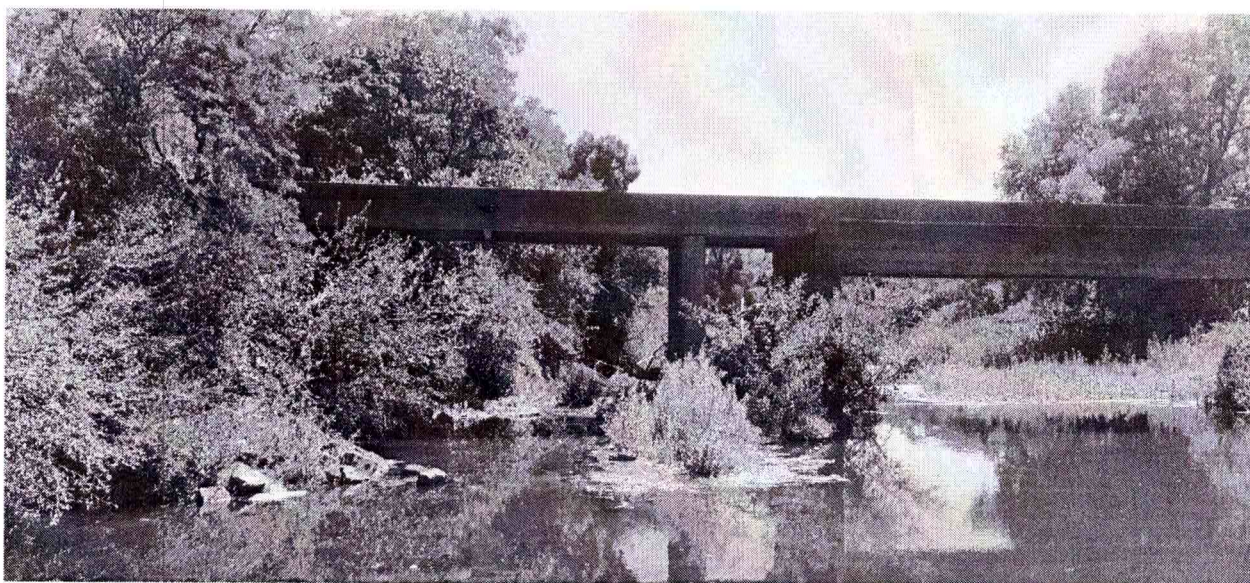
Vista Lateral da Ponte sobre o Arroio Ituzinho. (Foto Eng Thiago Piovezan)
